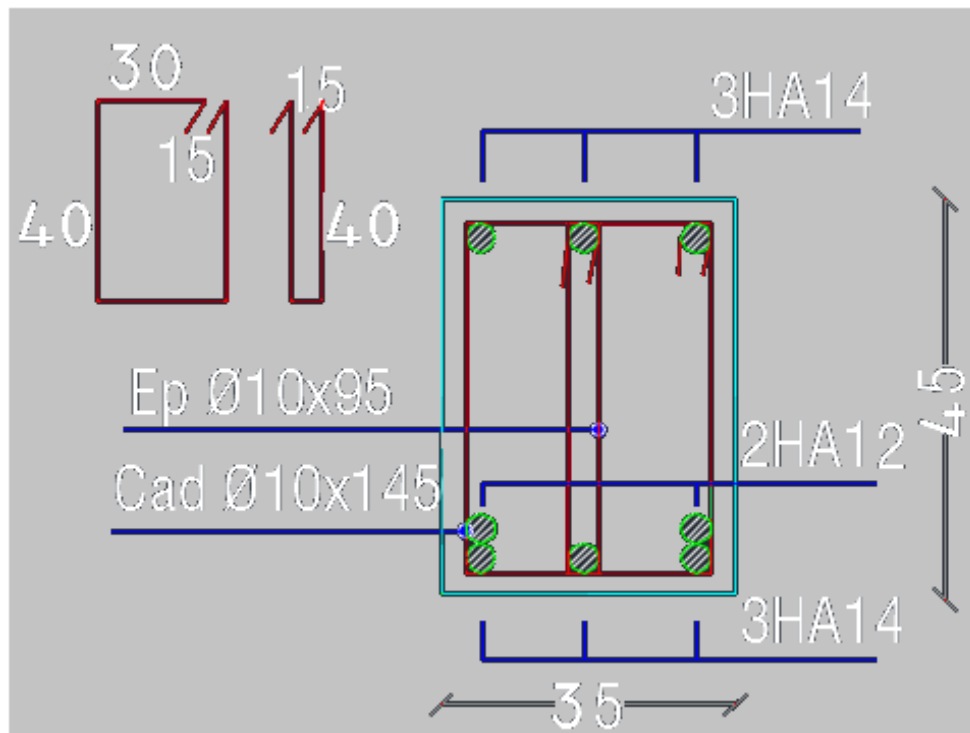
Ferrailage des poutres principales au niveau d'appuis et travée de niveaux terrasse.
